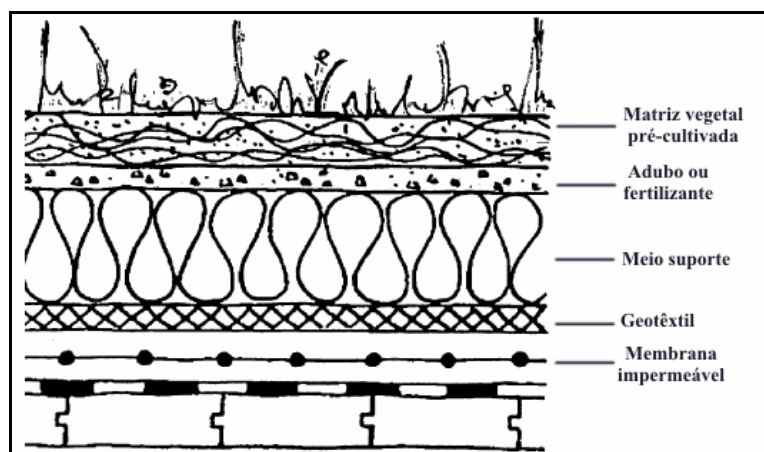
Perfil vertical de telhado armazenador (traduzido – EPA, 1999).
